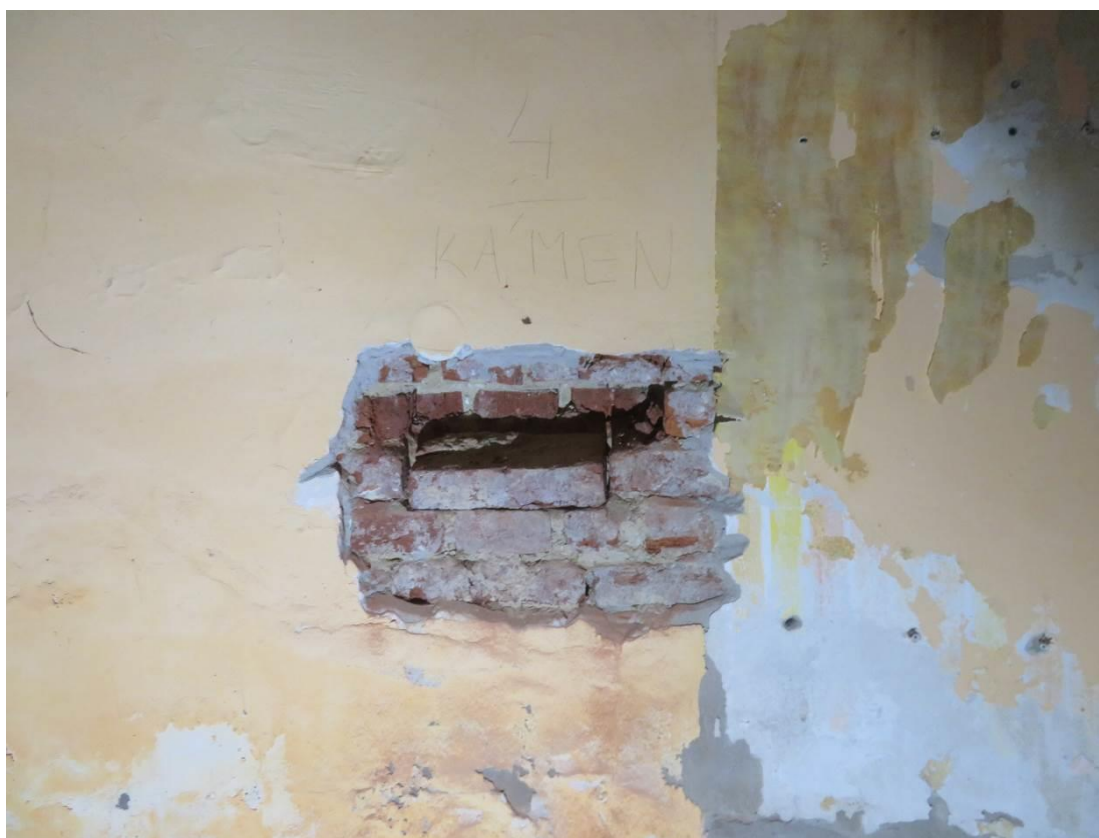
Zikova 1 – 1.PP – sonda Z1 – viditelné betonové cihly
